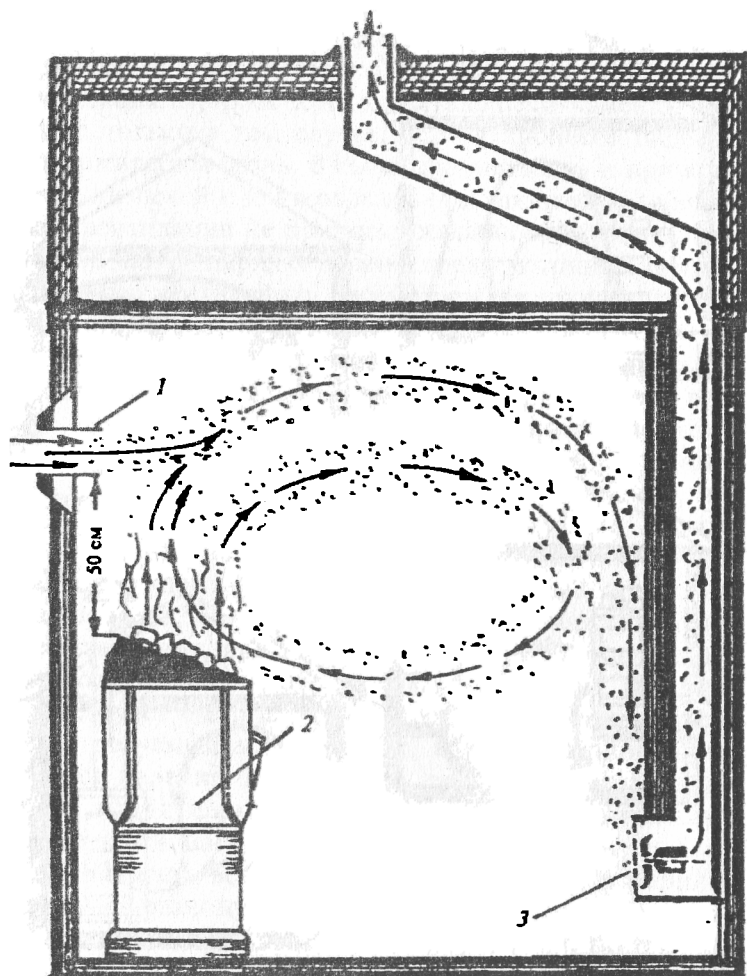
Движение воздушного потока при высоком расположении притока воздуха:
